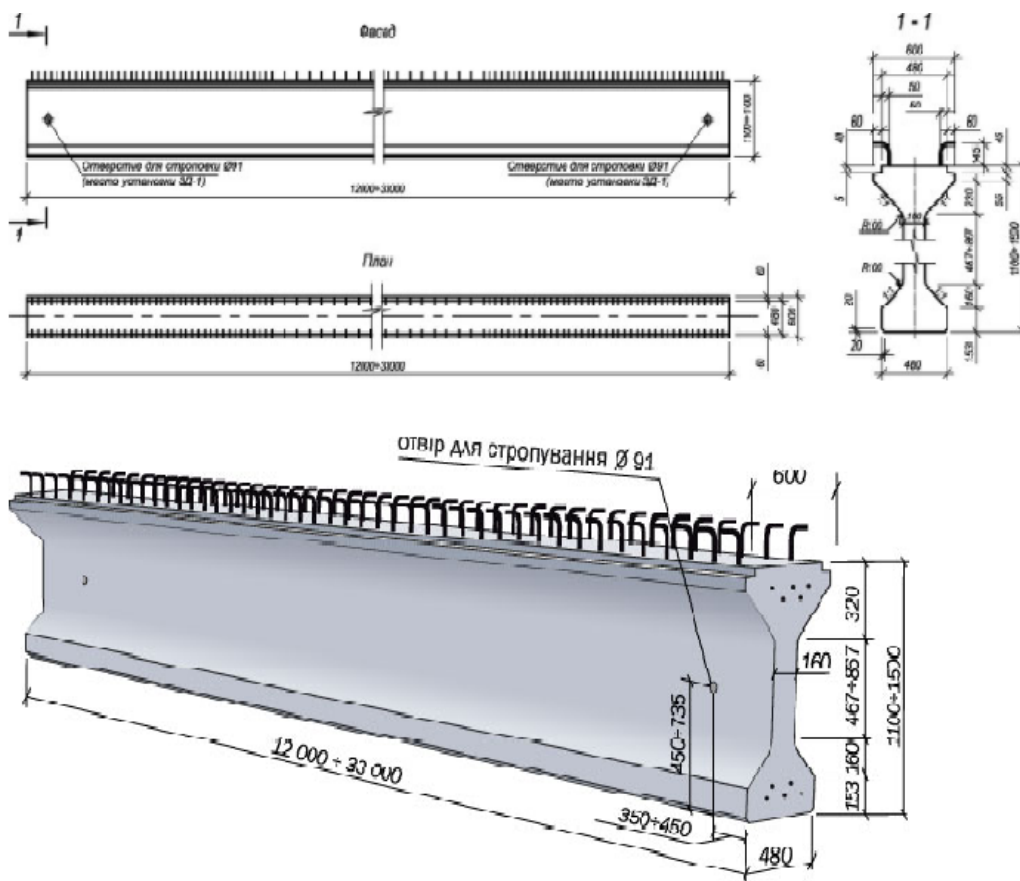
Попередньо напружена залізобетонна балка
